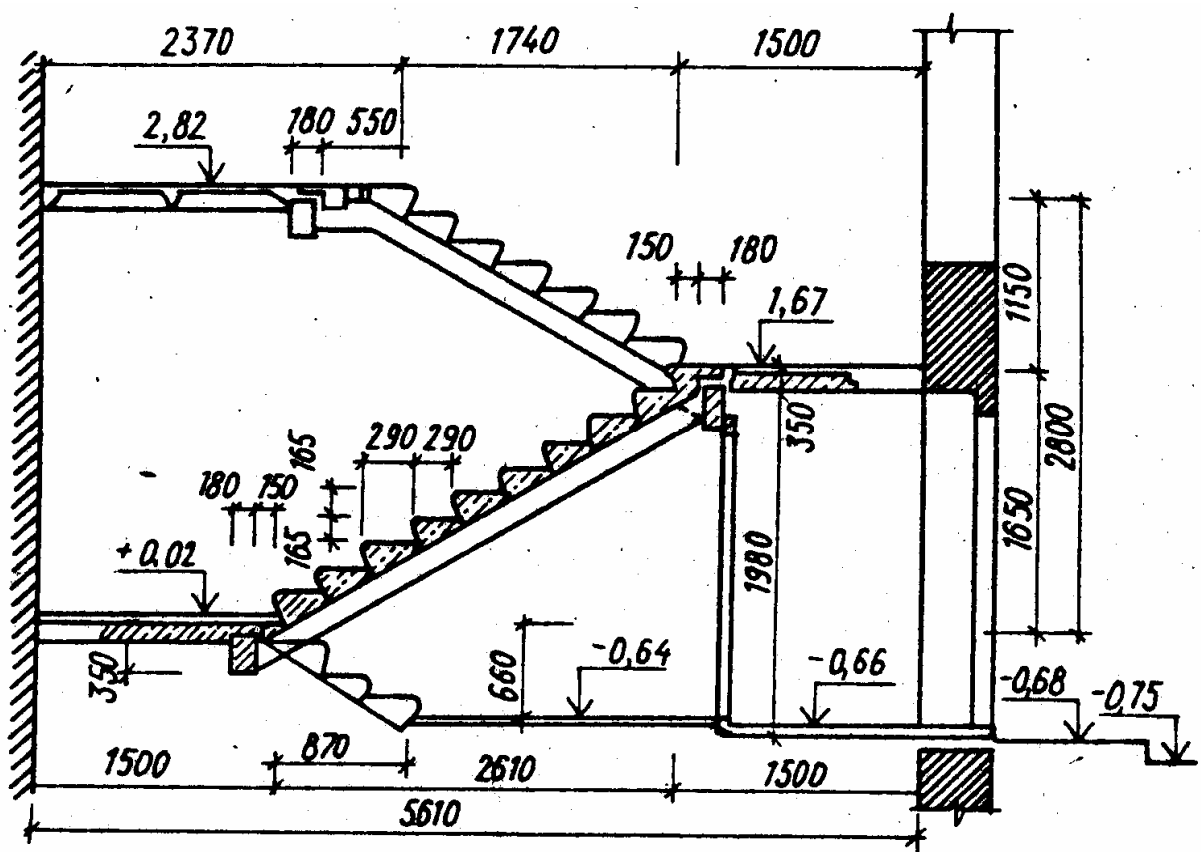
Схема сходів із збірних залізобетонних елементів
